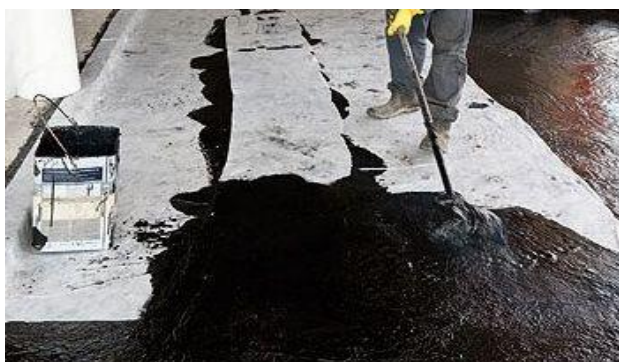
Impermeabilização aplicada a frio com estruturante
